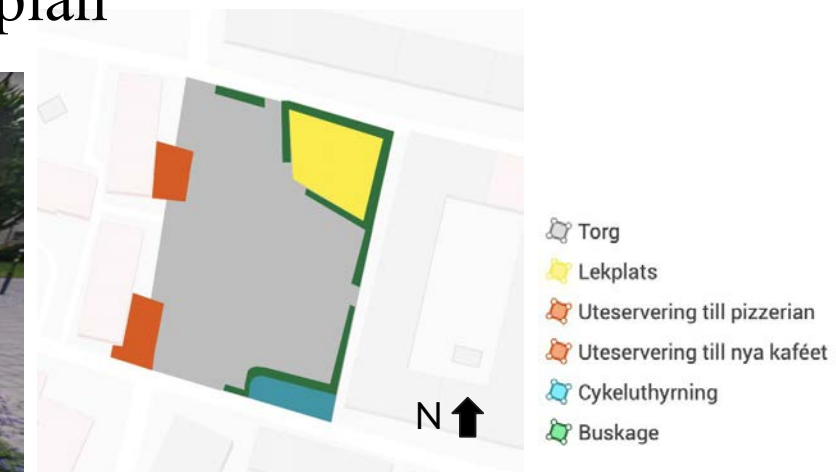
5 Skiss över tänkt förändring över Dalslandsplan
